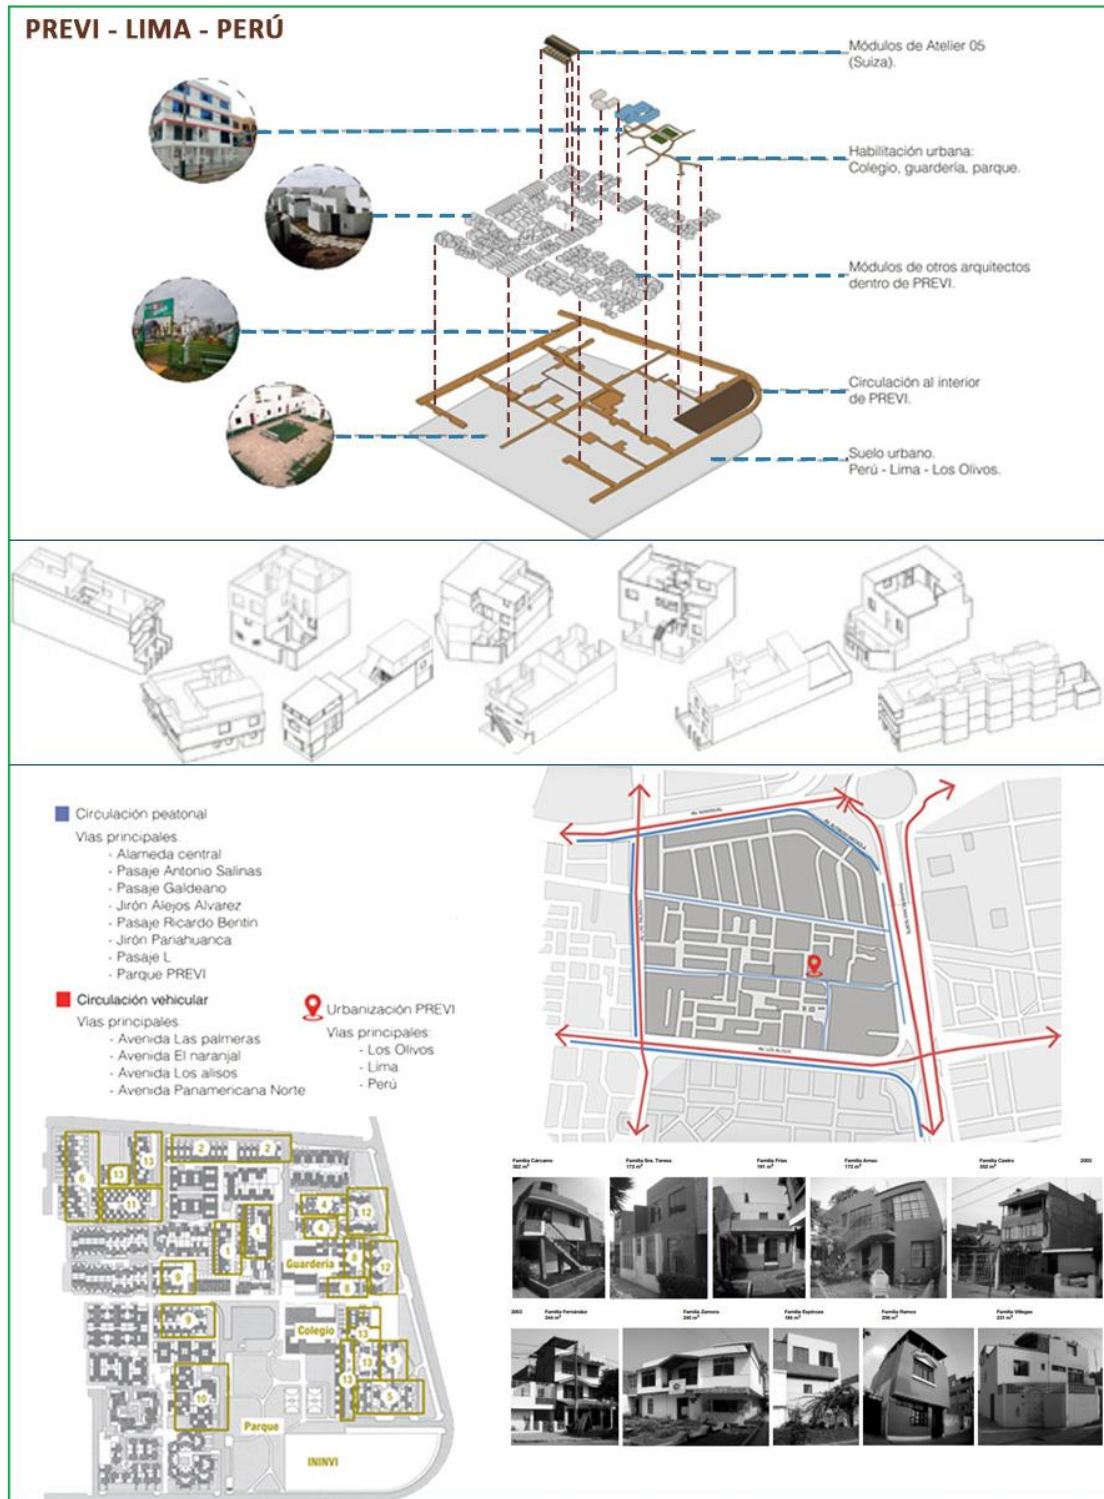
Análisis Arquitectura Flexible: Open building. (Fuente: elaboración propia)
